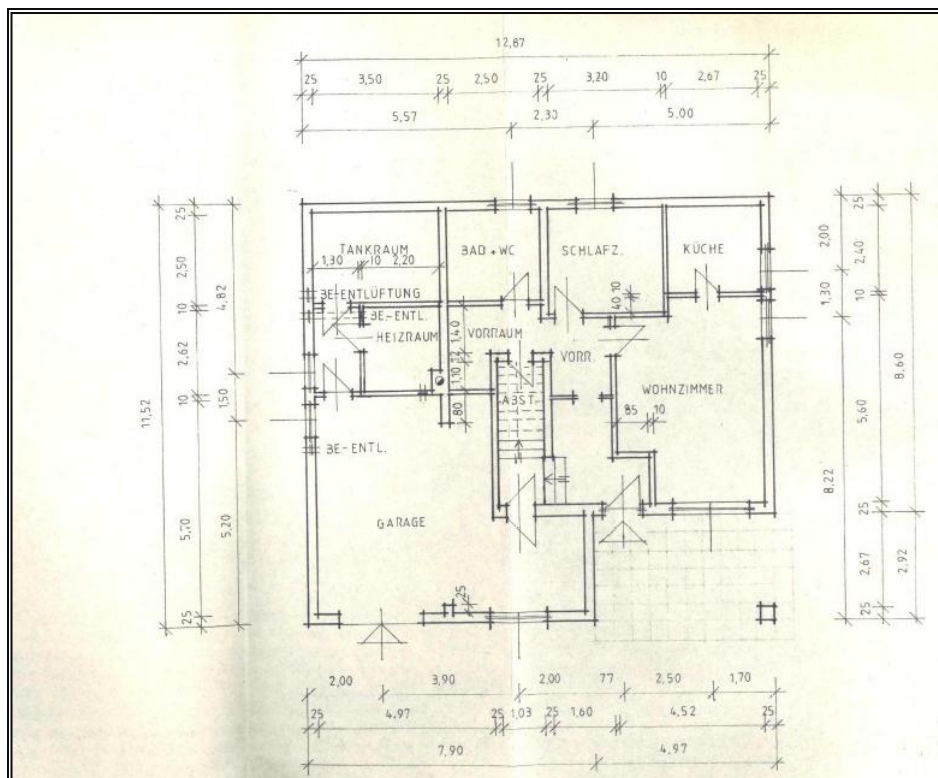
Grundrissplan EG des Bestandes aus dem Jahr 1989
